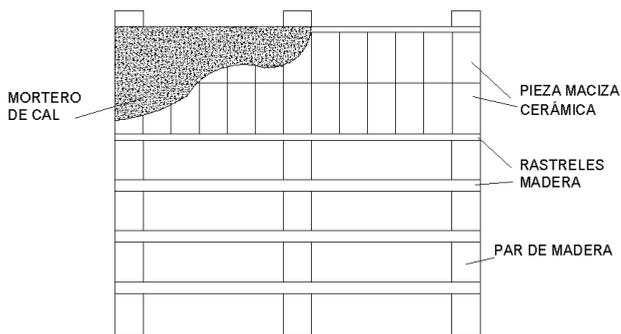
Detalle en planta de cubierta inclinada.2015.
